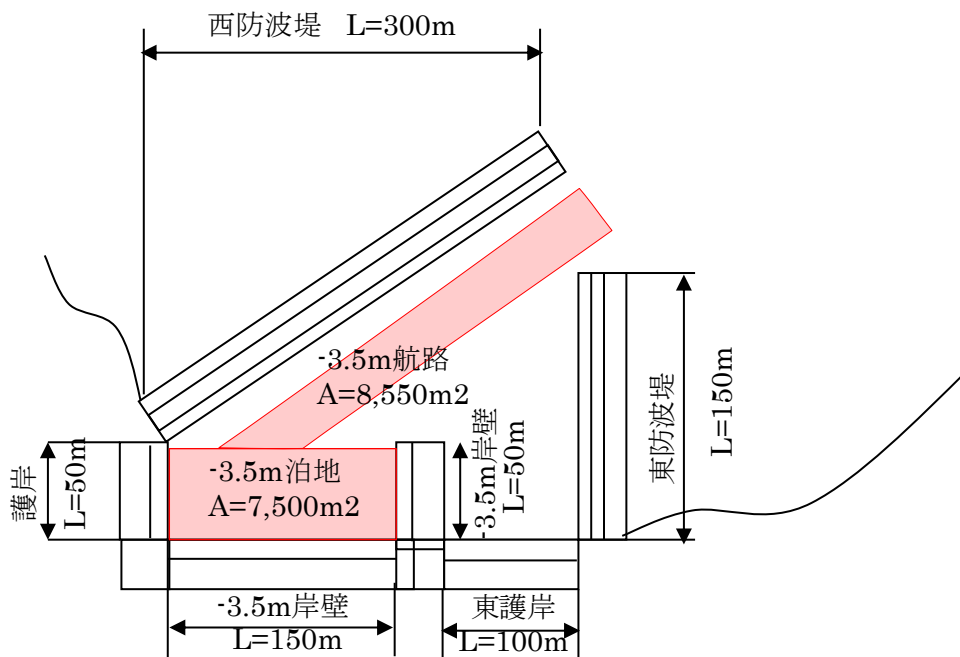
3.5m 航路·-3.5m 泊地平面图
